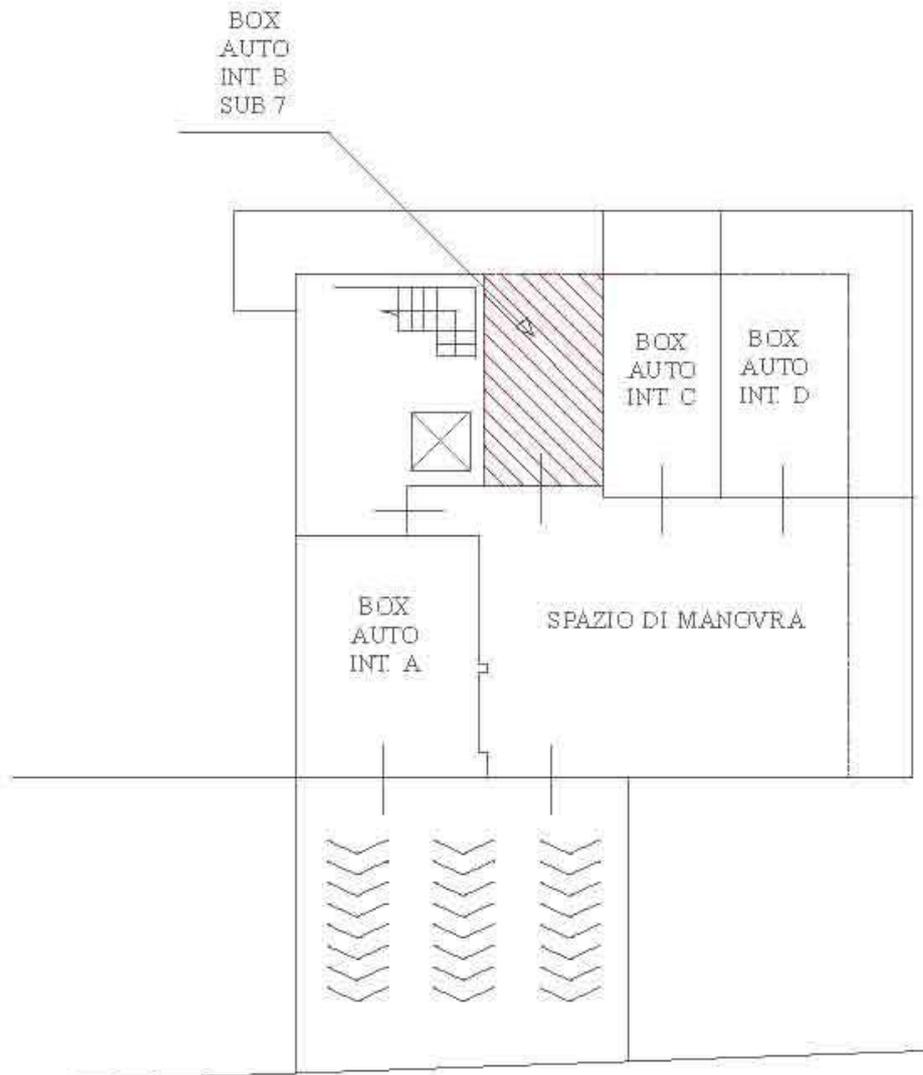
LOTTO N. 1 - RILIEVO METRICO BOX AUTO
